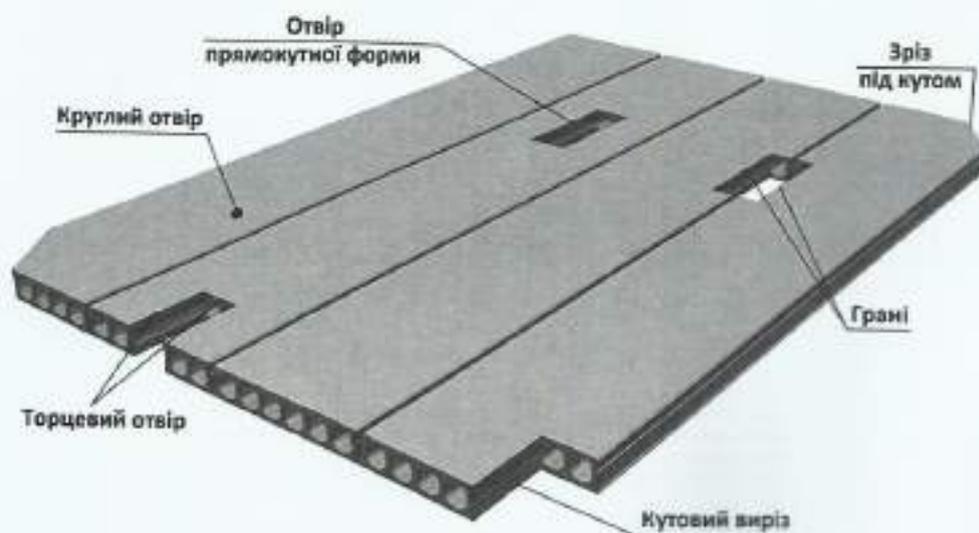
Залізобетонні плити переkritтя
